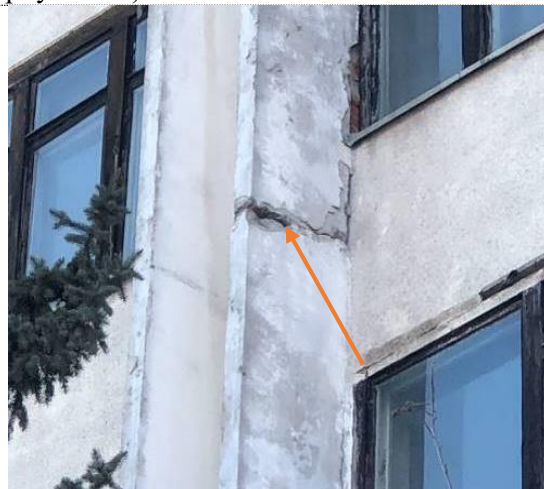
Участок разрушения стыковочного шва импостов (корпус 200В)
